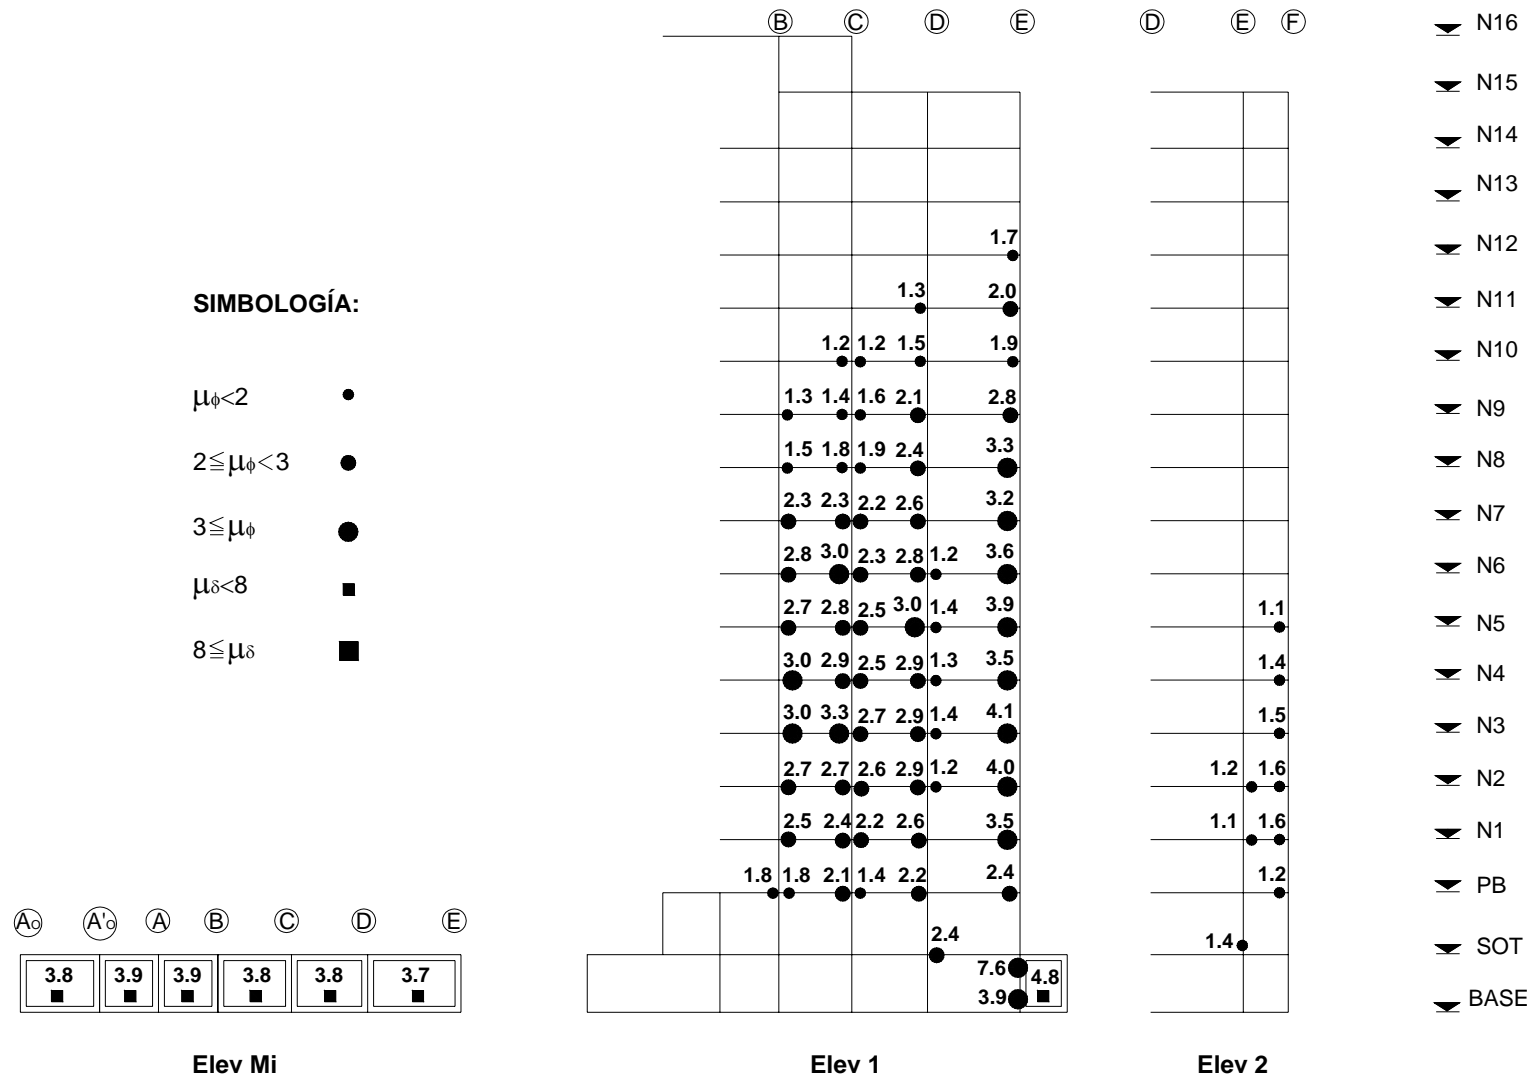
Ductilidades locales máximas de vigas, columnas y muros de concreto reforzado, en las elevaciones Mi, 1 y 2, para la SIM81
